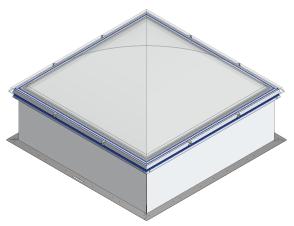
WiNa Stairvent après l'installation de toutes les chevilles
